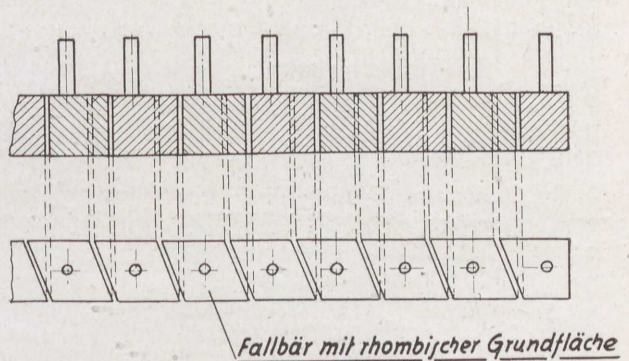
Hammerstampfmaschine. Jeder einzelne Hammerstamper hat rhombischen Querschnitt und stampft über die Fuge hinweg
